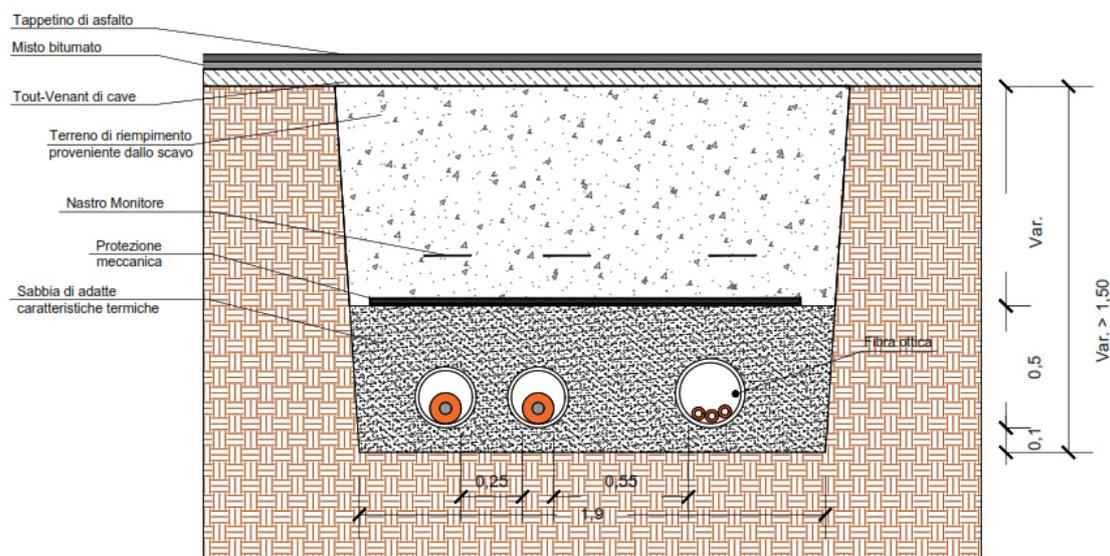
Sezione cavidotto terrestre su strada asfaltata
